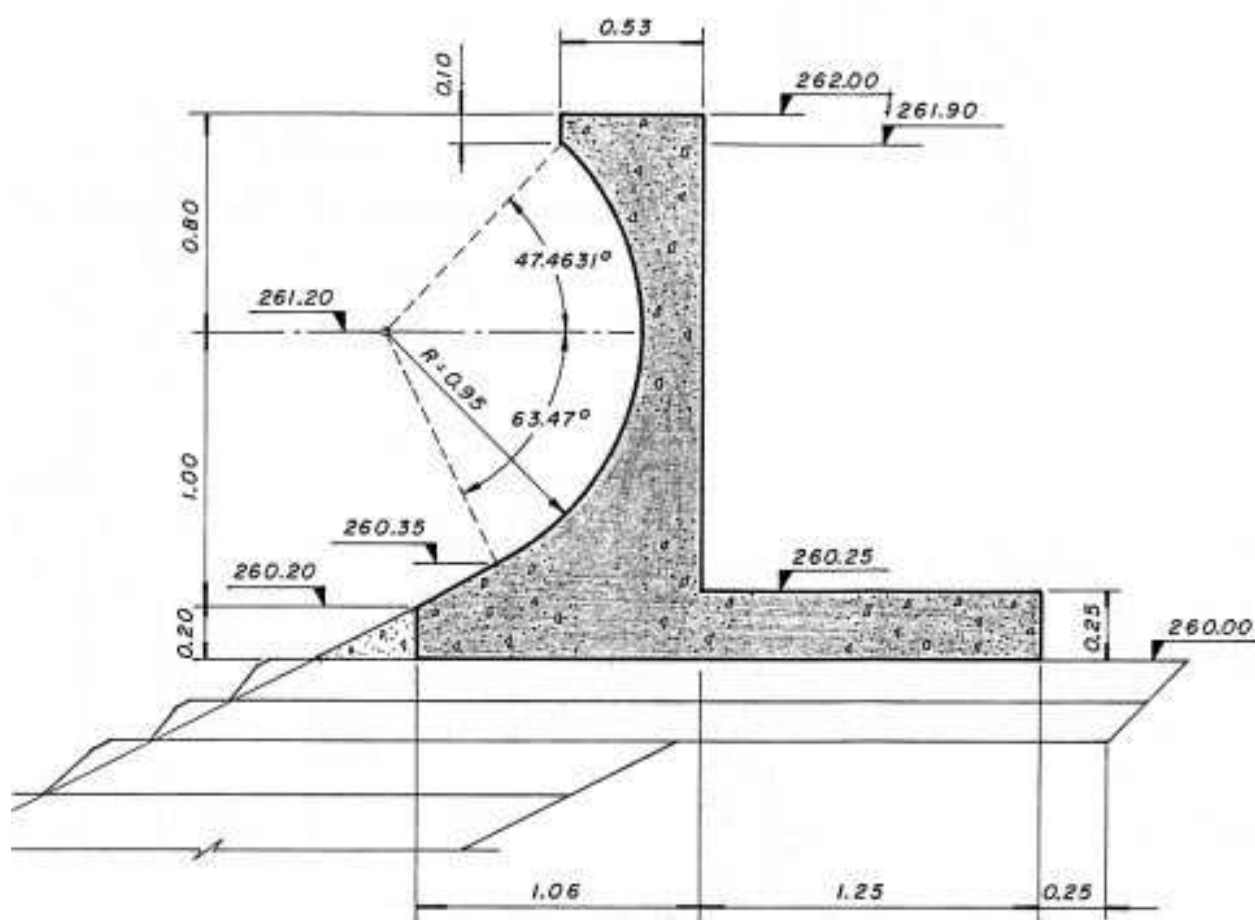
Wave Deflector Wall on the Dam Crest – Section - Barragem de Porto Primavera
